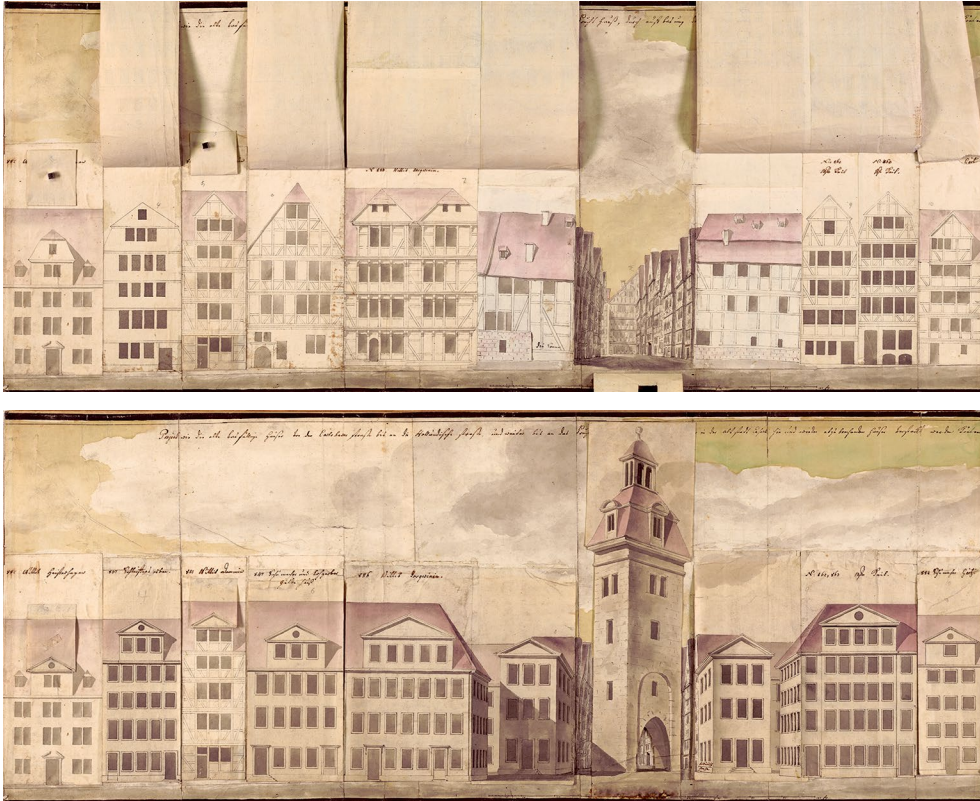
a–b. Simon Louis Du Ry, [Entwurf für die Vereinheitlichung der Fassaden am Müller Tor der Bremer Straße](#), 1776 (Ausschnitt). Fachwerk im klassizistischen ›Gewand‹.
